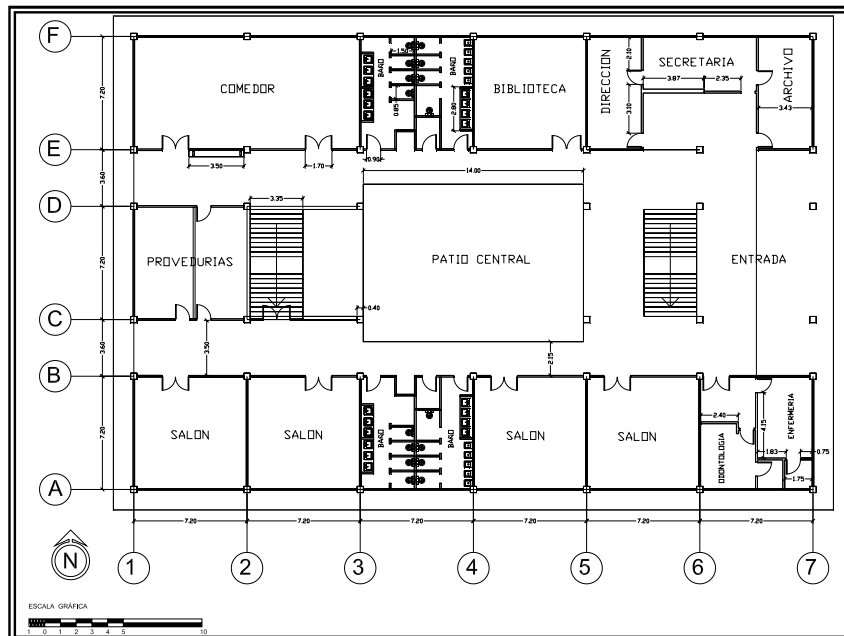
Plano de arquitectura de la planta baja, mostrando ubicación de paredes
